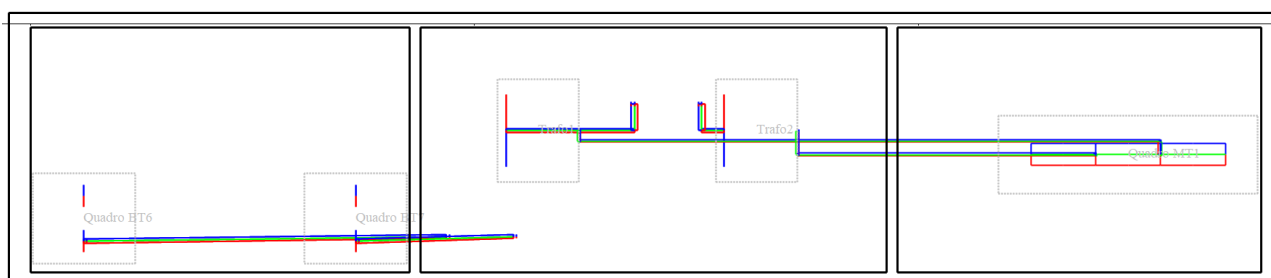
Layout del locale Cabina MT/BT piano terra – vista in pianta
